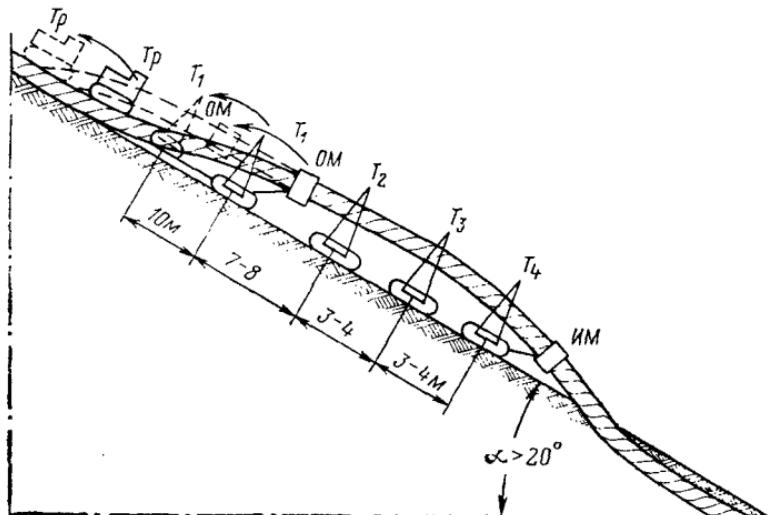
Схема расстановки механизмов при выполнении изоляционно-укладочных работ на уклонах более 20°
